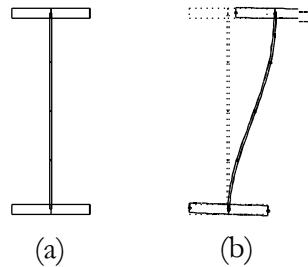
Exemple 3 : Instabilité distorsionnelle d'une section en I (Adany, 2004)
